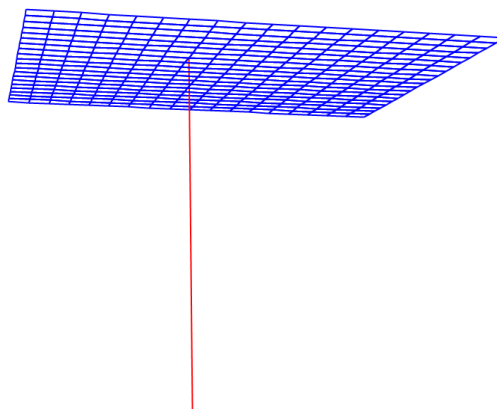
Ligação Laje-Pilar “FS” com pilar modelado em elemento de barra e a laje em elementos de casca.
